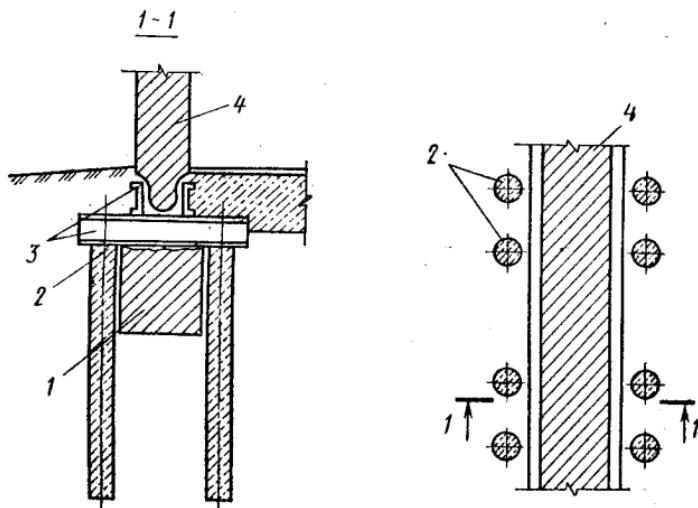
Усиление ленточного фундамента на естественном основании сваями с устройством рамной системы:
